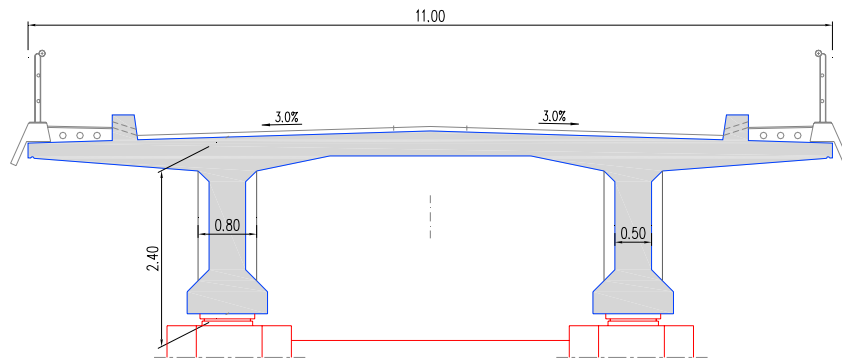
Secção transversal do tabuleiro da ponte. Secção de vão, sendo visível o alargamento das almas junto aos apoios.
